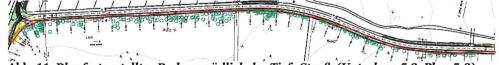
Planfestgestellter Radweg südlich der Tiefe Straße(Unterlage 5.3, Plan 5-3).
